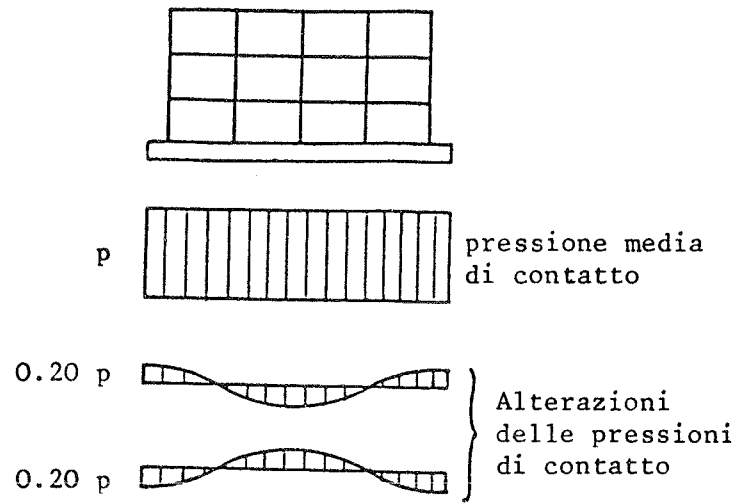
Schema di calcolo utilizzato per il dimensionamento delle travi parete
